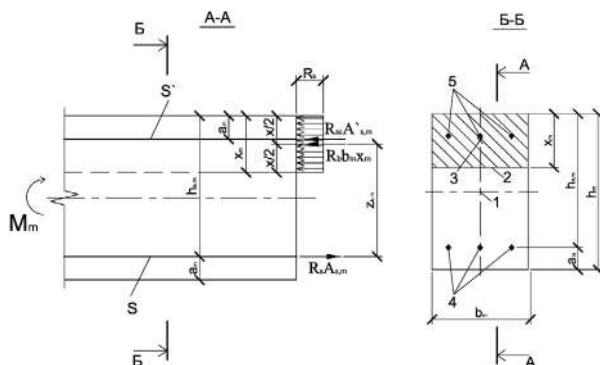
Схема к расчету модели железобетонной балки на прочность и деформации
